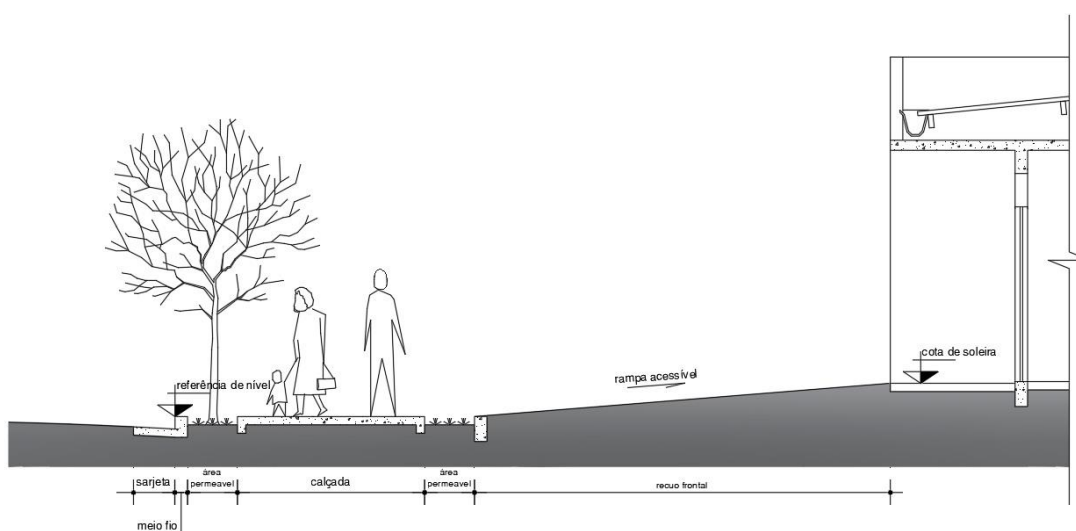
Corte longitudinal indicando cota de soleira. Fonte: Eng. Gustavo Reis
